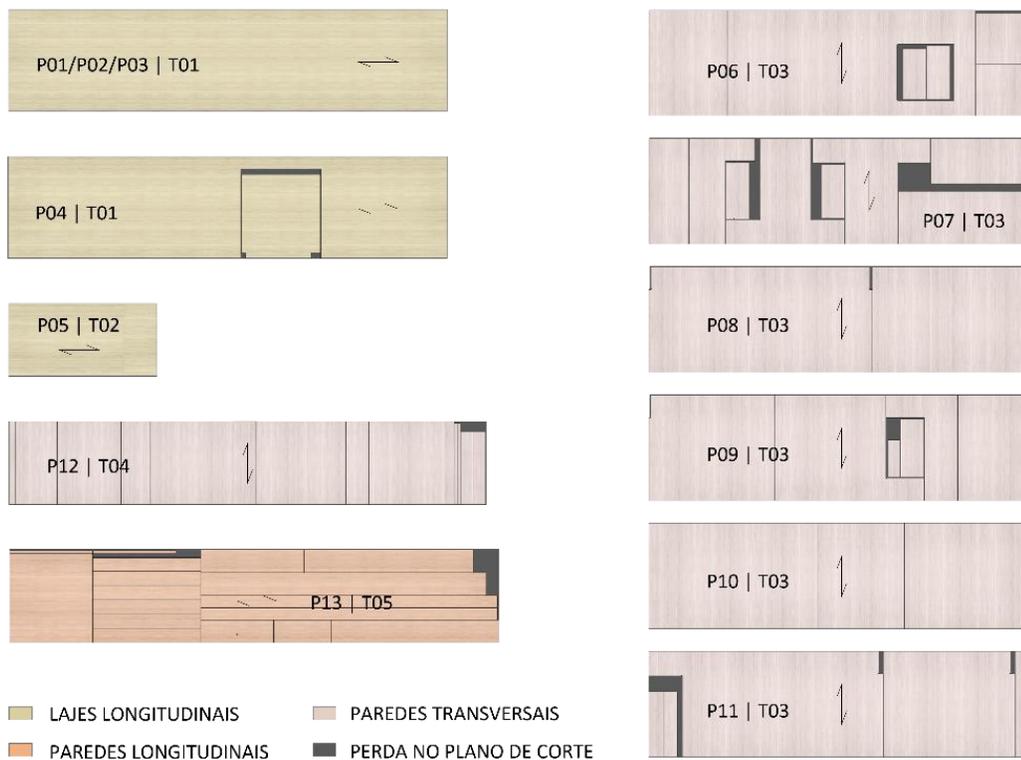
(continuação) Modelo tridimensional da estrutura (esq.) e Plano de Corte dos painéis de CLT a serem confeccionados (dir.) para o Caso 02.
